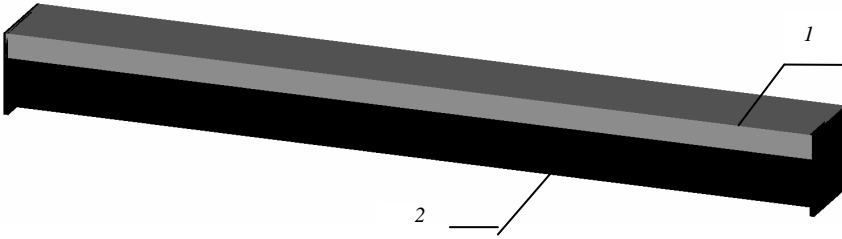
Схема сталезалізобетонної таврової балки з армуванням вертикальними листами
